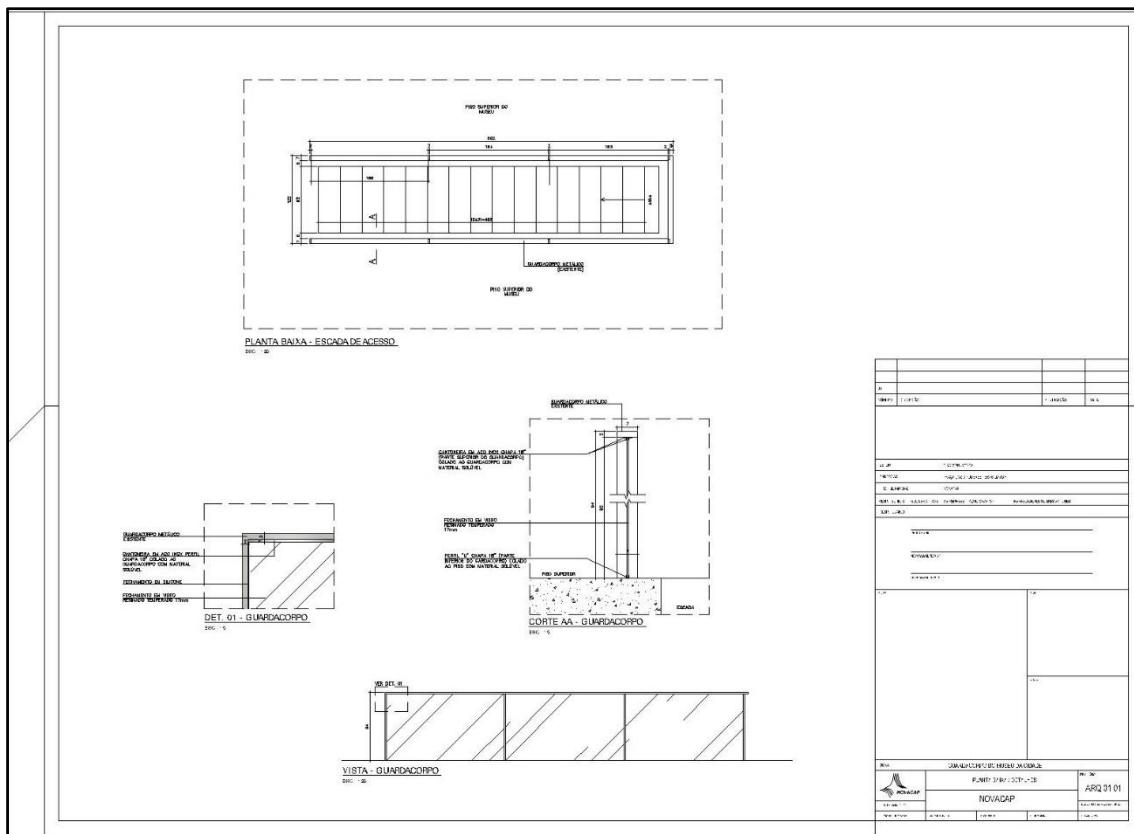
Abr. 2011 – Museu da Cidade. ARQ 01/01. Escalas 1:20 e 1:5. Guarda-Corpo – Planta Baixa - Detalhes. NOVACAP. Arquivo: PLANTA BAIXA - ESCADA-Model. Fonte: SUPAC/SECULT-DF.
